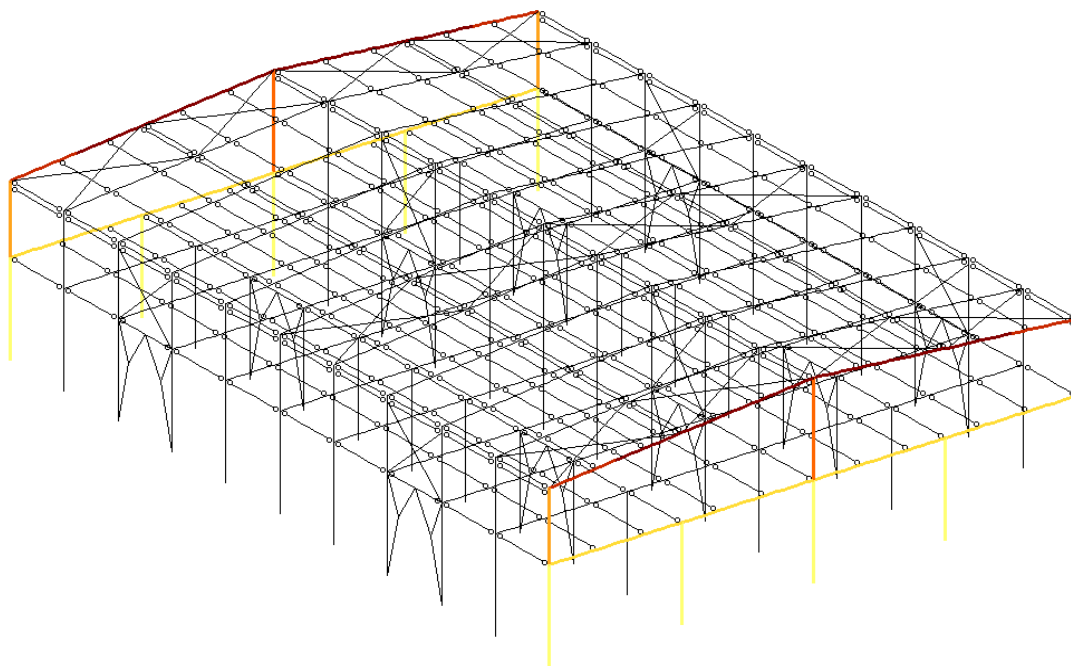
Мозаика ветровых нагрузок на фасад А-Д
